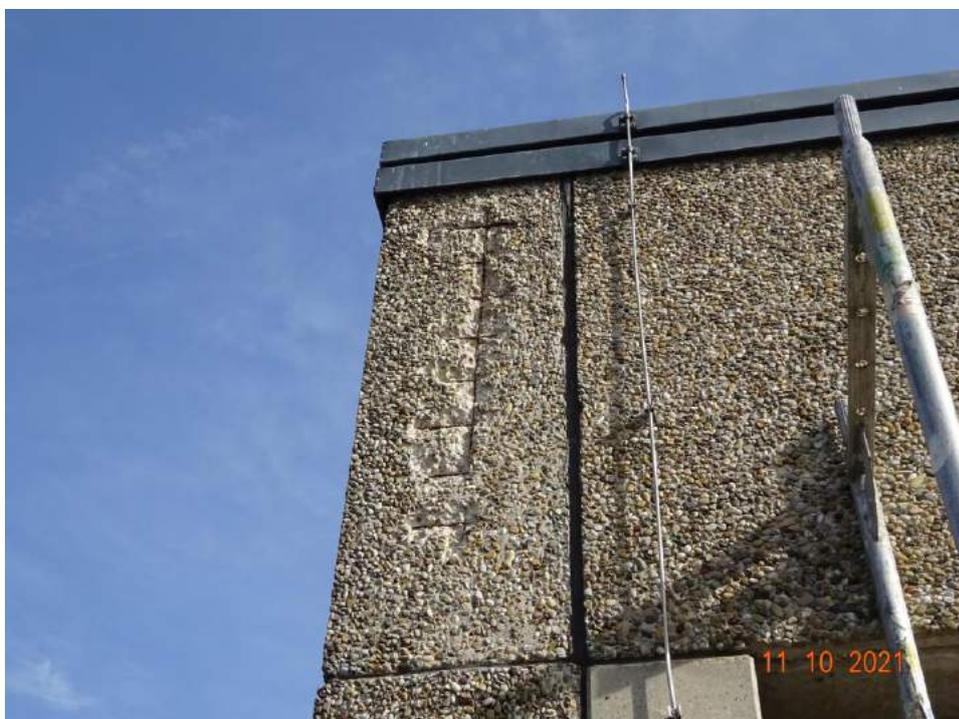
Waschbetonplatte Hallengebäude, flächige Betonabplatzung mit freiliegender korrodierter Bewehrung
